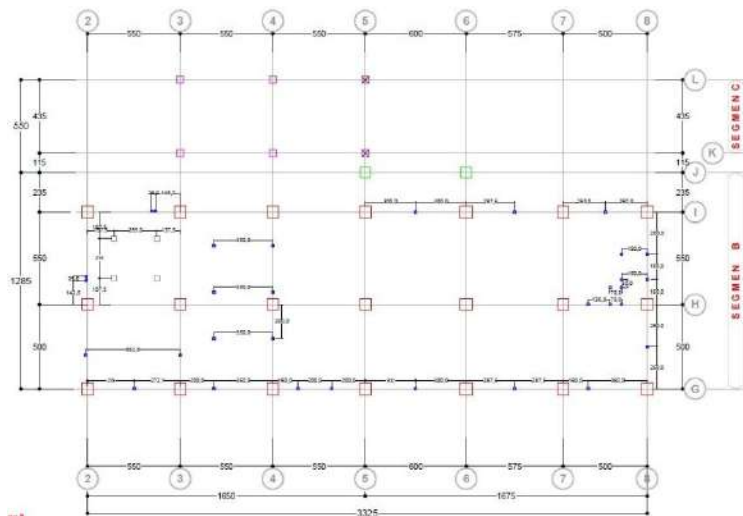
4 Layout Perencanaan Lantai Dasar Gedung Perkantoran BPKAD Provinsi Sulawesi Tengah
